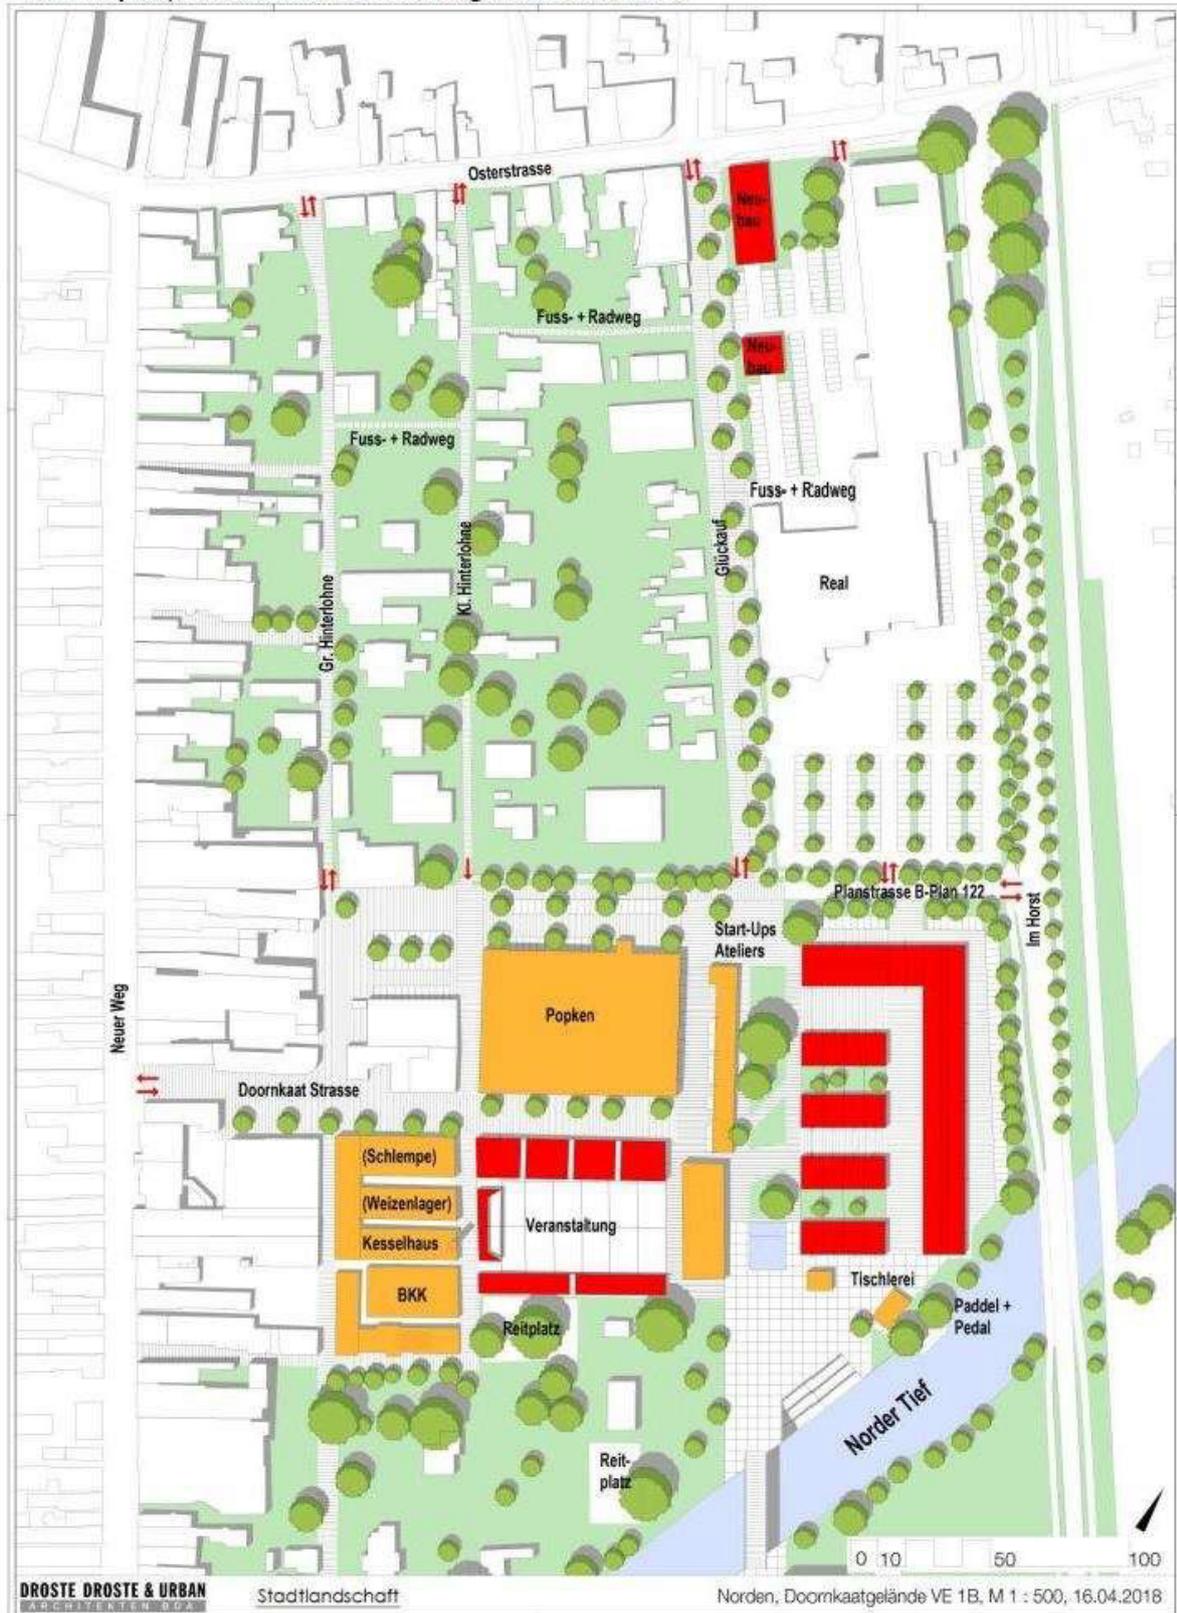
Rahmenplan Doornkaatgelände (Variante A)
